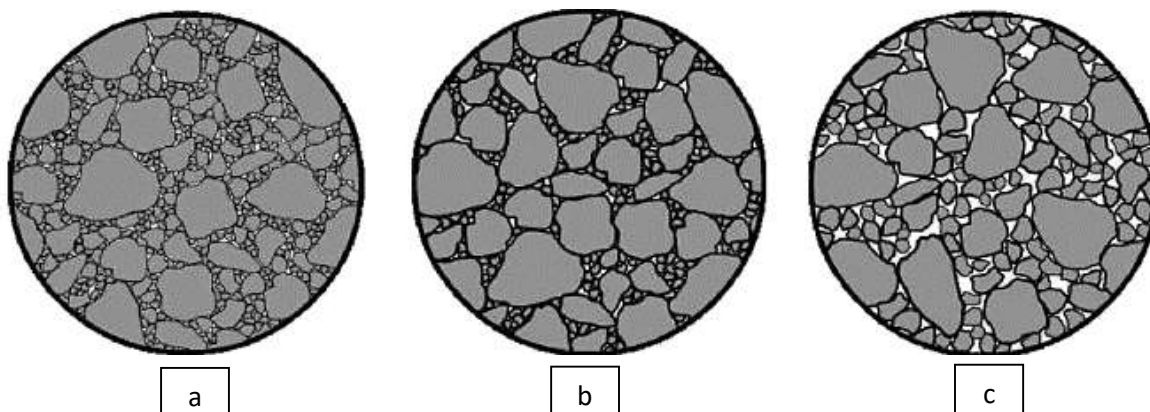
Tipos de mezclas asfálticas: a) Densa, b) SMA, c) Abierta. Fuente: [pavementengineering.blogspot.com](http://pavementengineering.blogspot.com)
